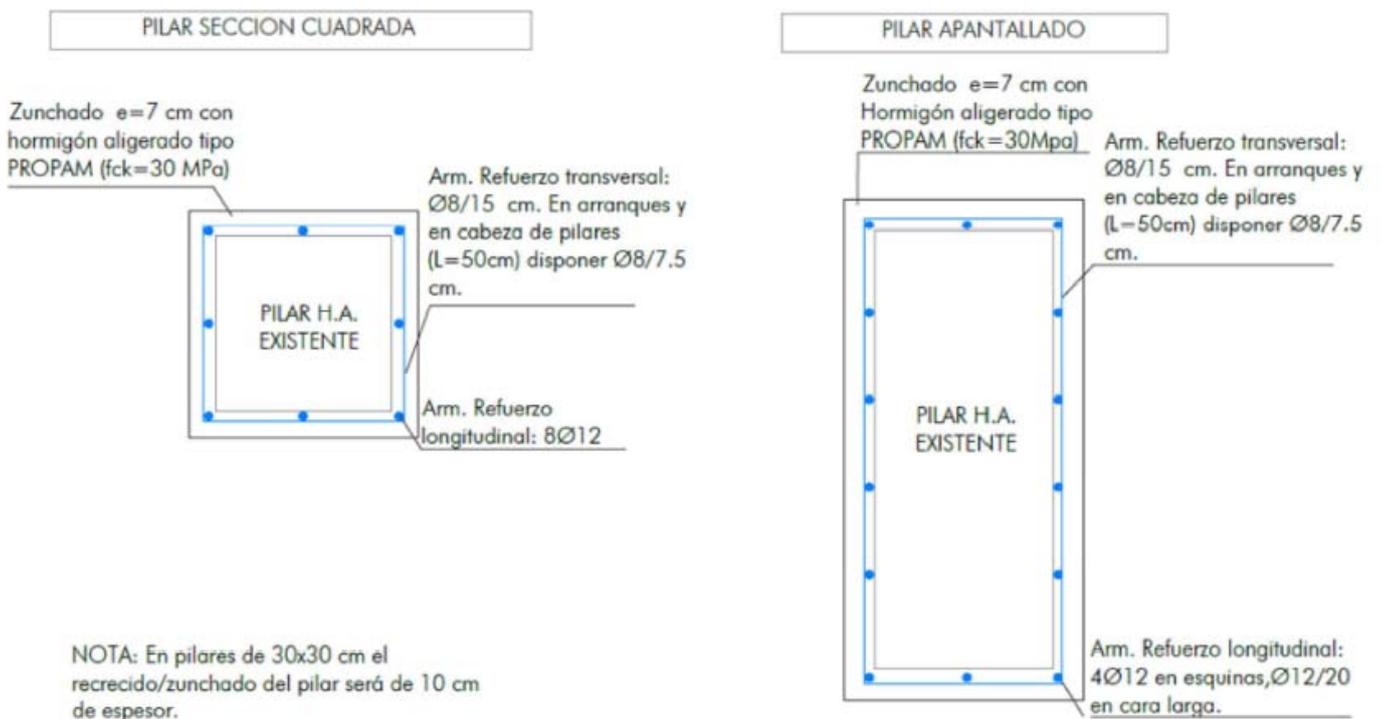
Detalles genéricos de zunchado de pilares tipo.
